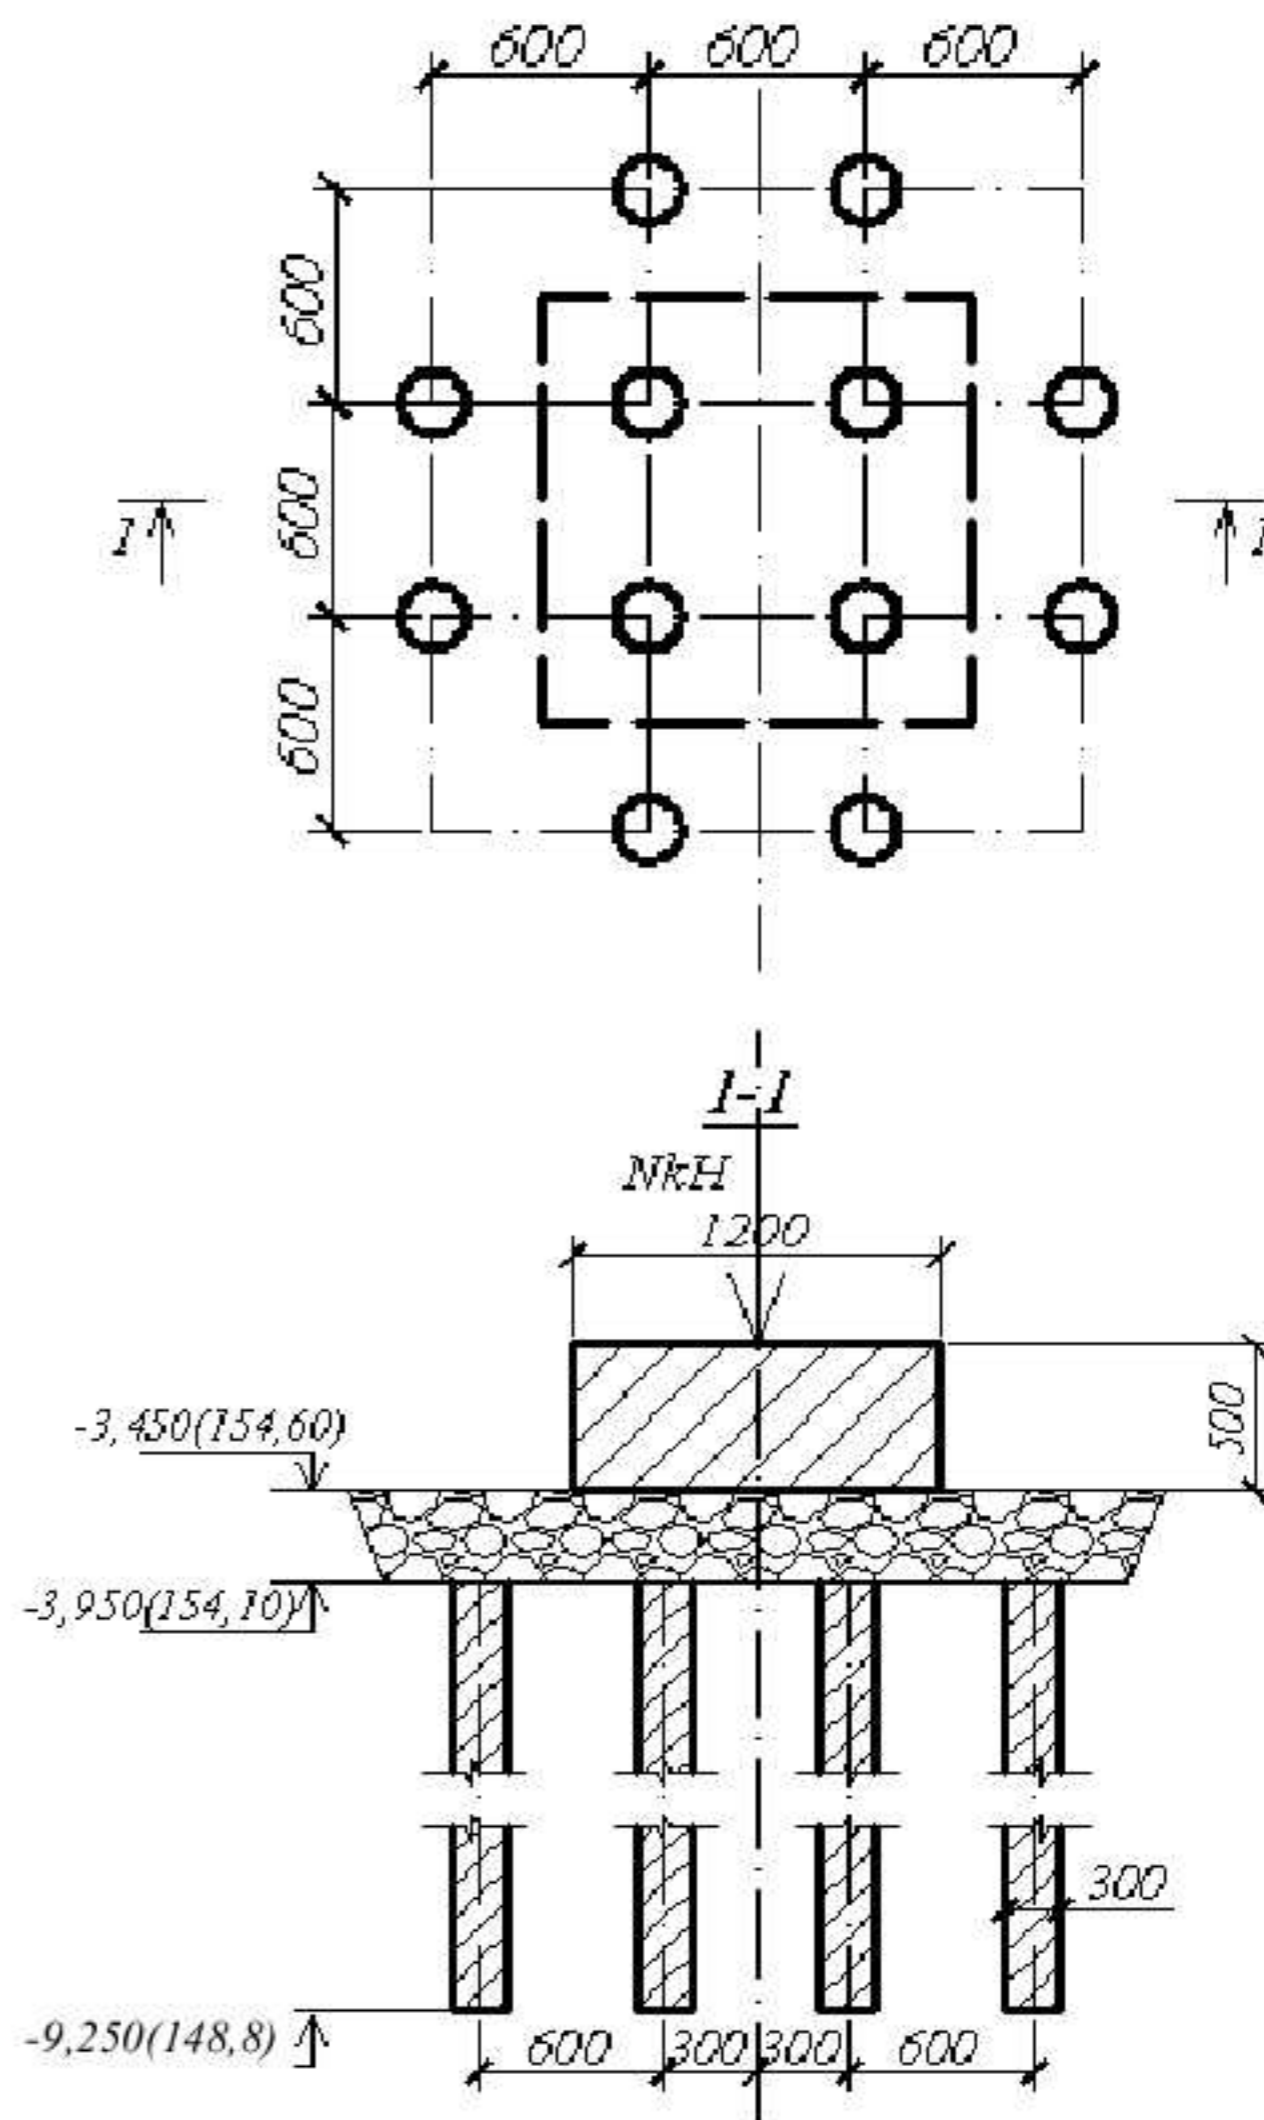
Схема випробувань штампом основи, яка армована вертикальними ґрунтоцементними елементами.
